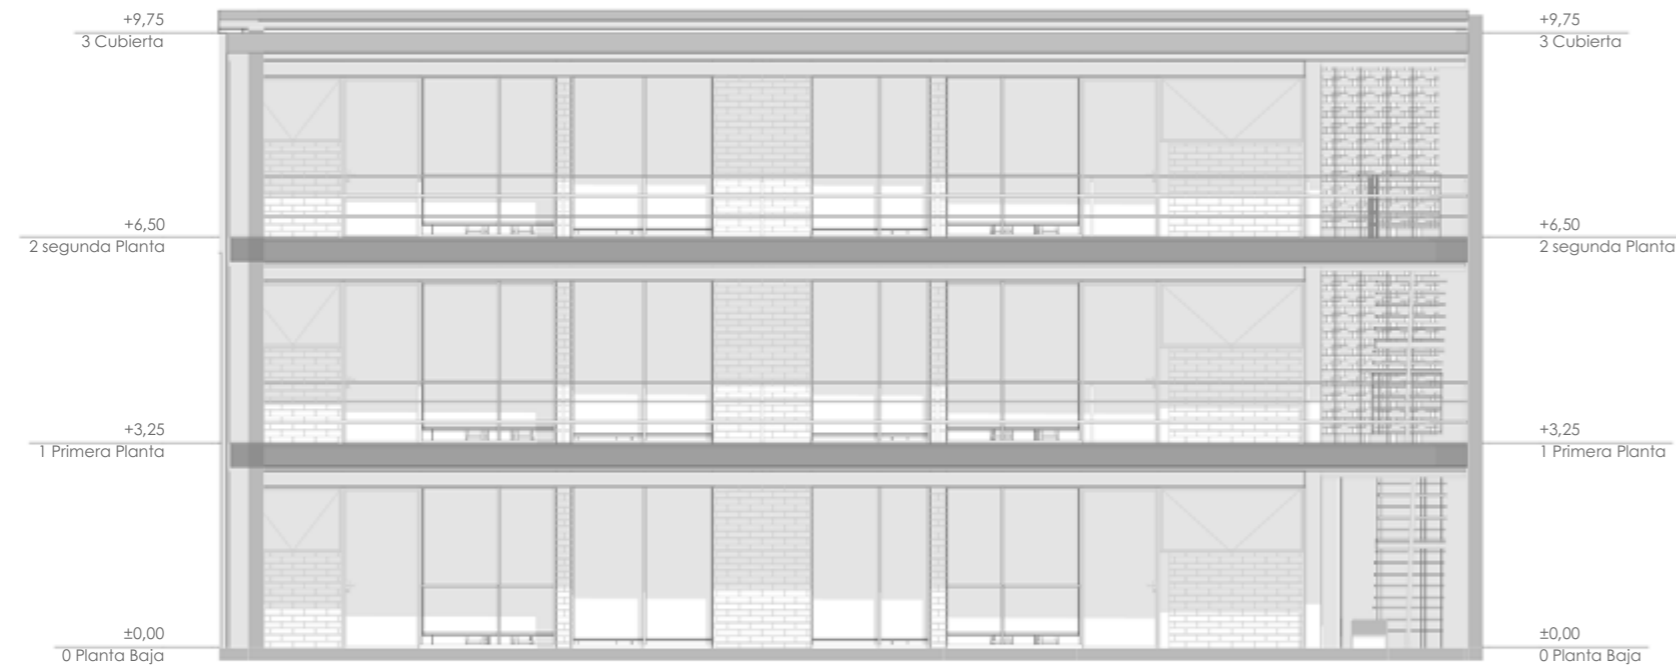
Fachada frontal bloque 3. Nota. Elaboración propia
